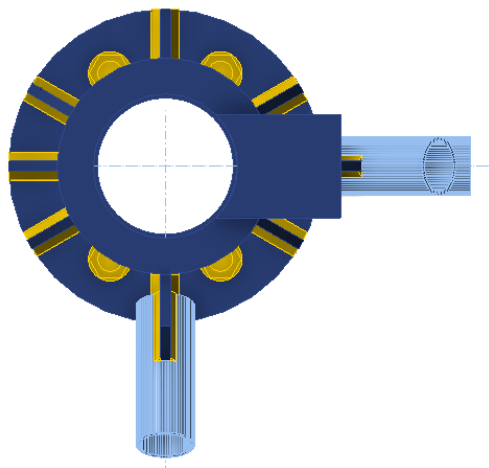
Розріз монтажної стики верхнього поясу просторового блоку ферми
